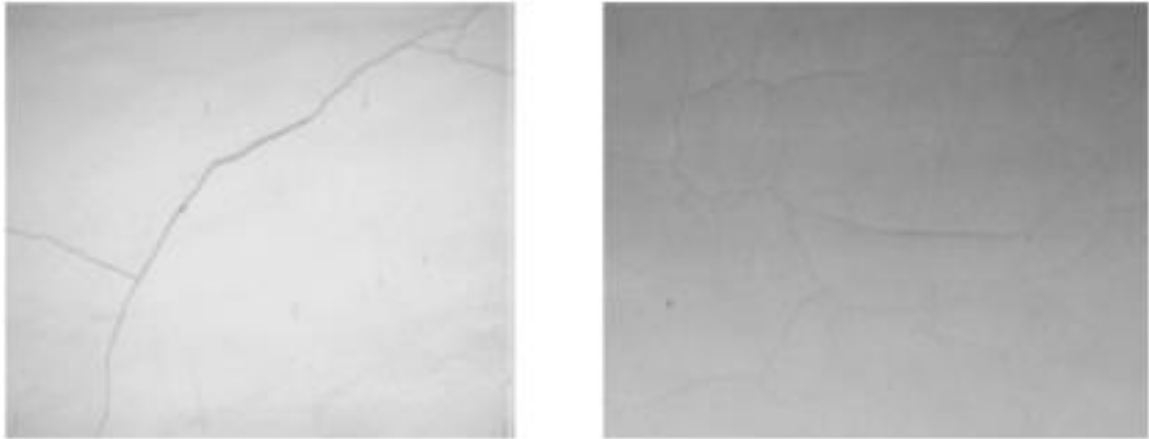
Fendilhação (à esquerda) e Fissuração (à direita)
